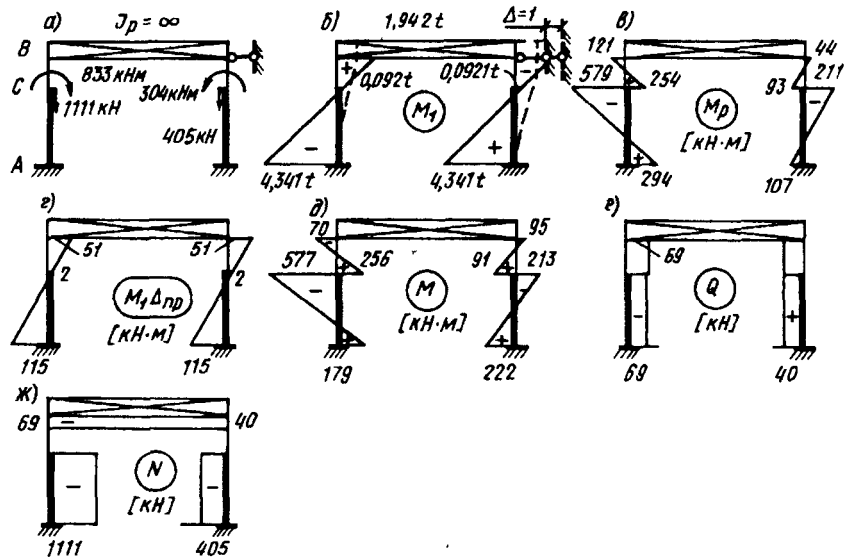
К расчету рамы на вертикальную нагрузку от мостовых кранов
